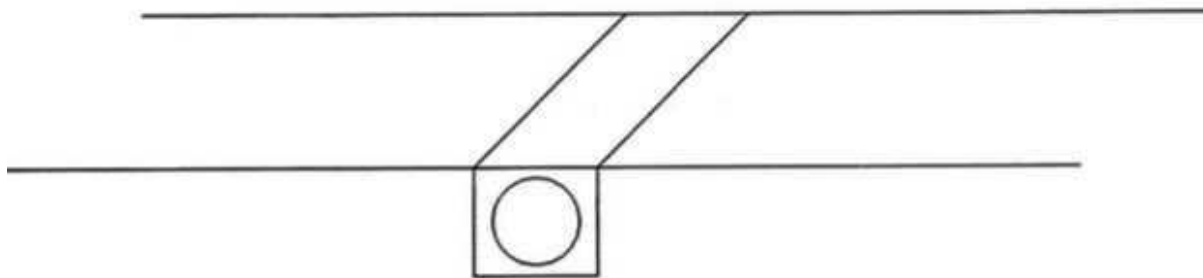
Projeto de Adequação de estradas rurais de Toledo, Paraná – fase de drenagem
